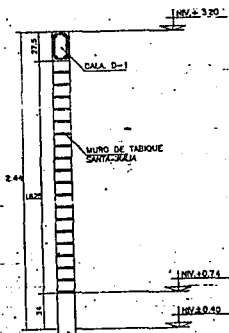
SECCIONES TRANSVERSALES DE ZAPATAS
